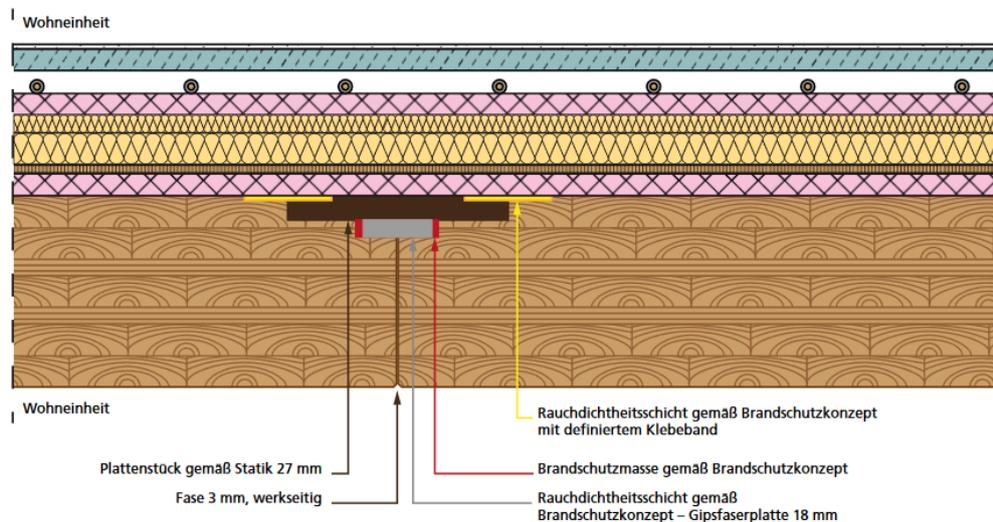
Detail Deckenstoss (Quelle: Holzbau Deutschland-Institut nach Kaden + Lager GmbH, Ed. Züblin AG, bauart Konstruktions GmbH & Co. KG, Dehne Kruse Brandschutzingenieure GmbH & Co KG)
